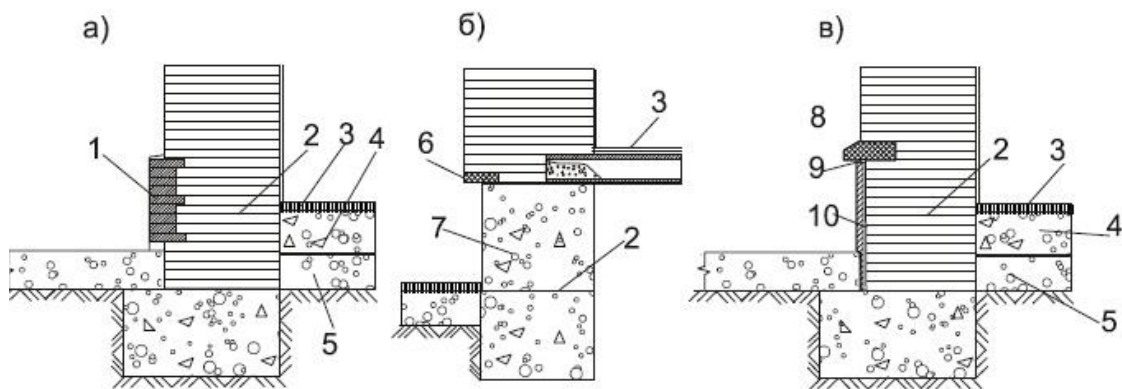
Цоколи кирпичных стен: а) облицованный отборным кирпичом; б) из бетонных блоков; в) облицованный тесаными плитами из натурального камня: 1 – лицевой кирпич; 2 – гидроизоляционный слой; 3 – пол первого этажа; 4 – бетонная подготовка; 5 – уплотненный грунт; 6 – кордон из железобетонных брусьев; 7 – стена подвала из бетонных блоков; 8 – кордонный камень; 9 – осадочный зазор; 10 – каменные плиты.
